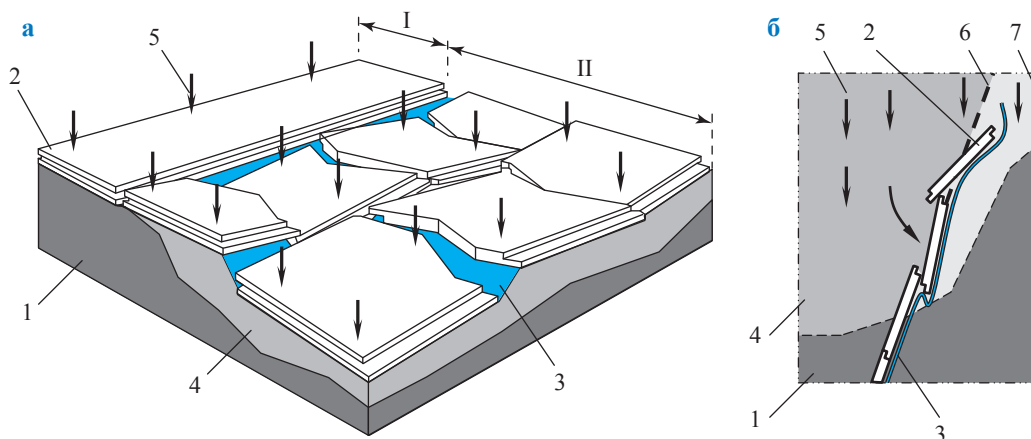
Схемы развития повреждений теплоизоляции плитами: осадка, смещение и разрушение теплоизоляционных плит (а) (I – исходное состояние; II – поврежденное состояние теплоизоляции); смещение плит при оттаивании мерзлого грунта у стенок траншеи (б), где 1 – мерзлый грунт; 2 – жесткая (теплоизоляционная плита); 3 – полотно из нетканого синтетического материала; 4 – талый грунт; 5 – направление воздействия нагрузок со стороны вышележащих слоев грунта; 6 – стенка траншеи; 7 – грунт талый с ненарушенной структурой
